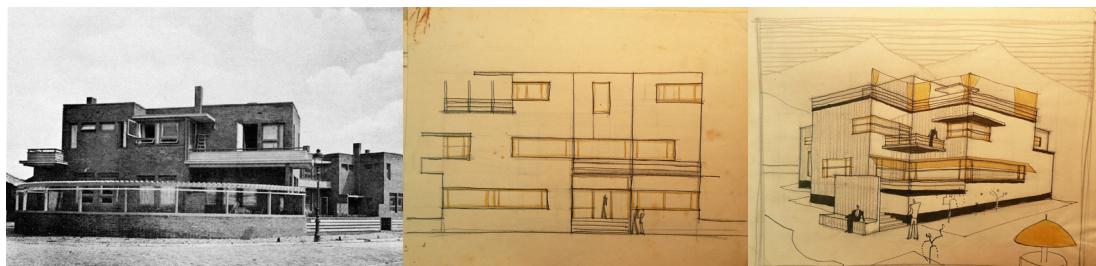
Estudio de alzado para la Casa en Ondarreta, 1928. Archivo Labayen.
